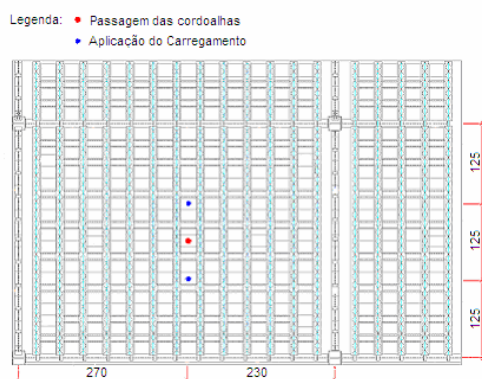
Esquema e vista dos pontos de passagem da cordoalha pela laje e dos pontos de aplicação do carregamento concentrado nos terços do menor vão.
